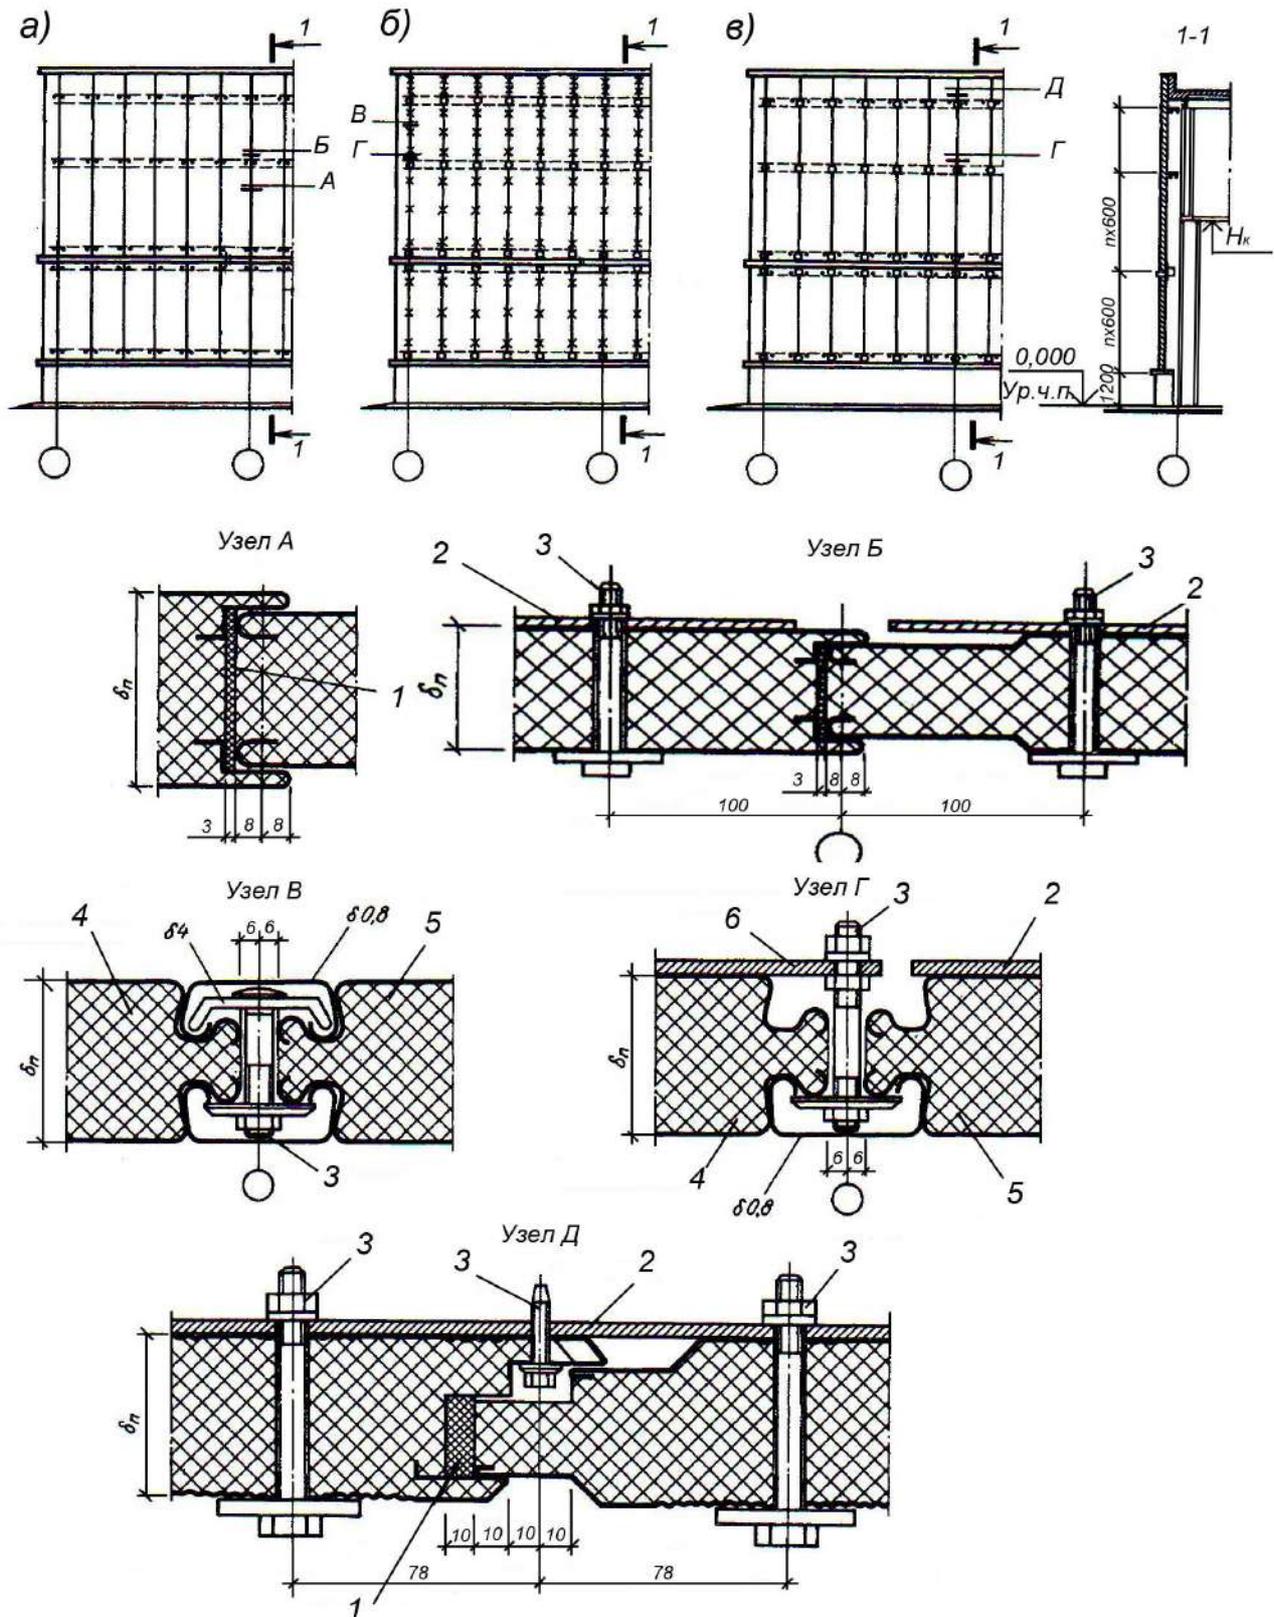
Стены одноэтажных промышленных зданий из металлических трехслойных панелей типа «сэндвич». Схемы крепления панелей:
